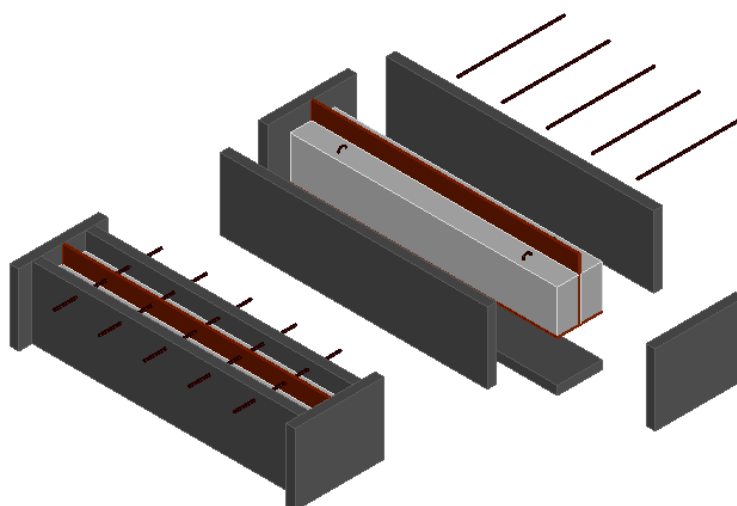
Esquema da cofragem das vigas em CAD®
